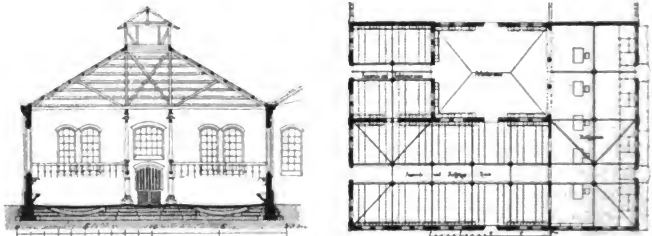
Schnitt und Grundriß der Schweineschlachthalle.
